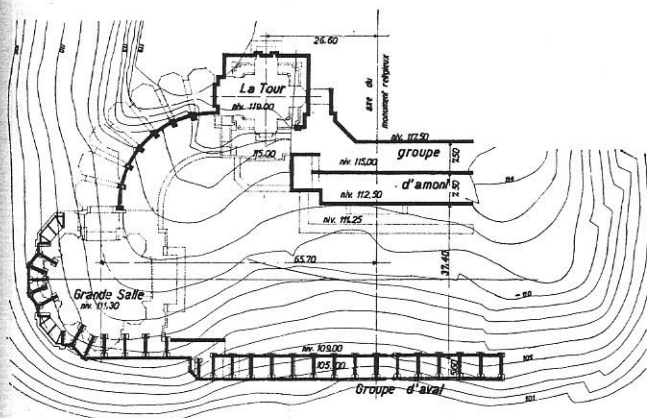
Aménagement de la butte Saint-Maur. Plan d'implantation des différents groupes de murs de soutènement.
